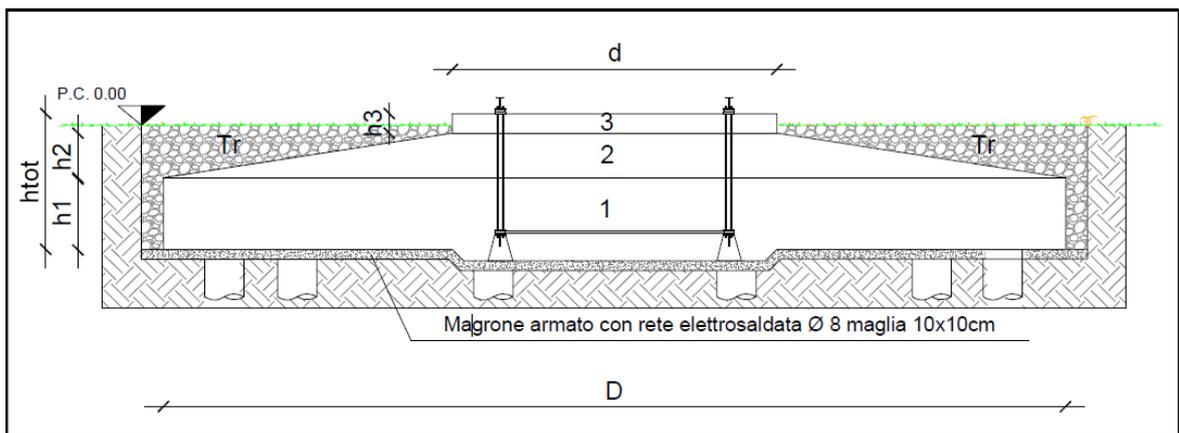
Fondazione - Dettaglio modello per calcolo volumi
